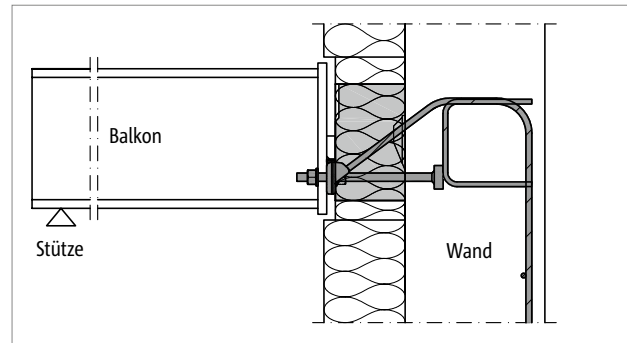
Schöck Isokorb® XT Typ SQP-WU: Sonderkonstruktion; erforderlich bei Anschluss an eine Stahlbetonwand
